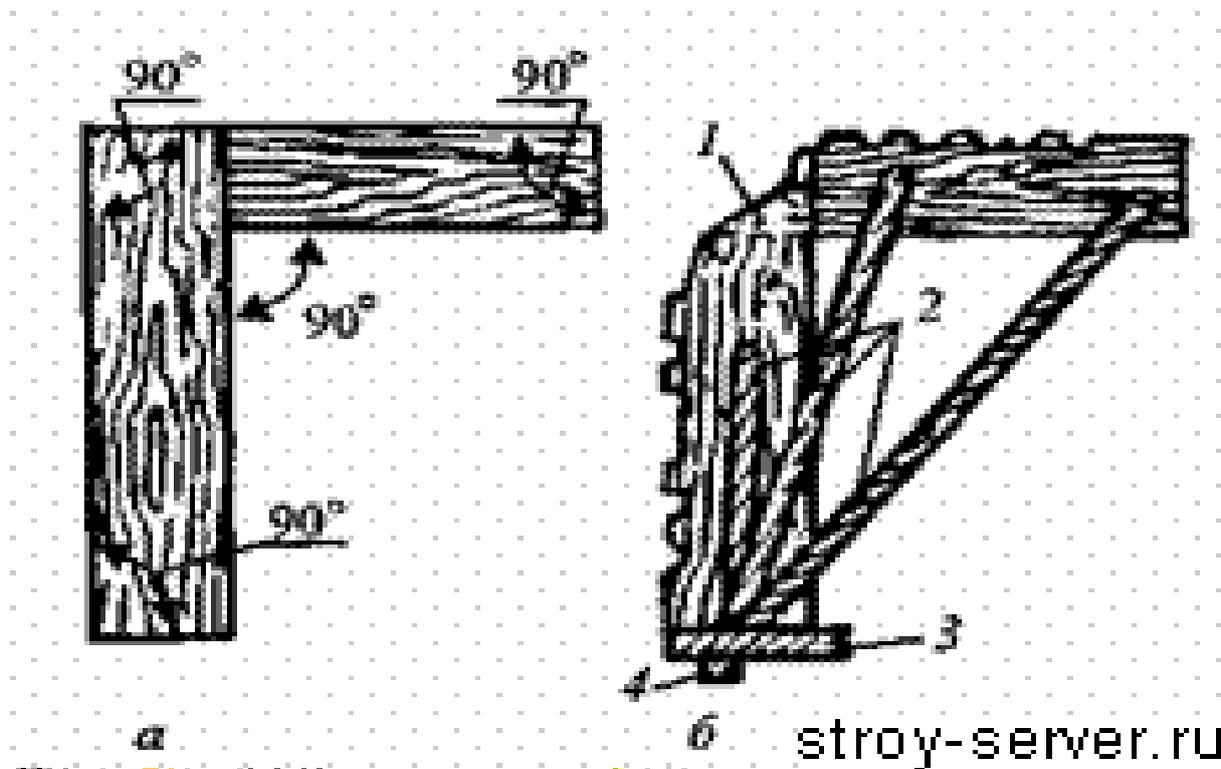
Изготовление большого шаблона: а — заготовка; б — шаблон; 1 — профильная доска; 2 — подкосы; 3 — салазки; 4 — полозок
